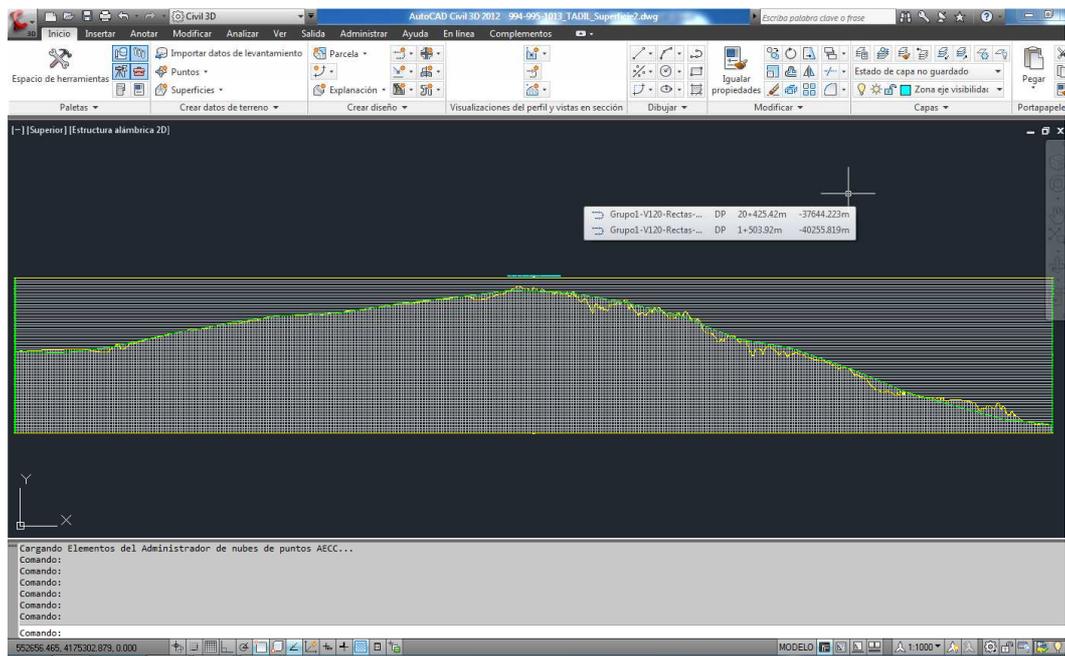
Perfil longitudinal de la envolvente de máximos.
